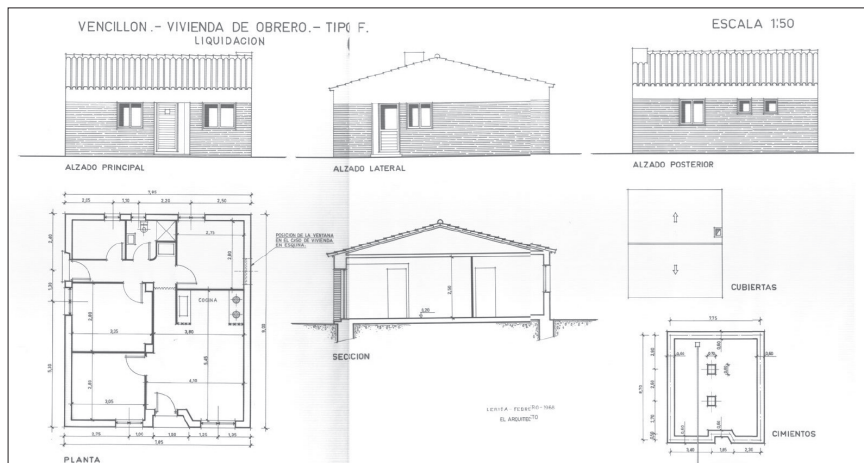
Tipologías de vivienda: casa de obrero tipo F.
